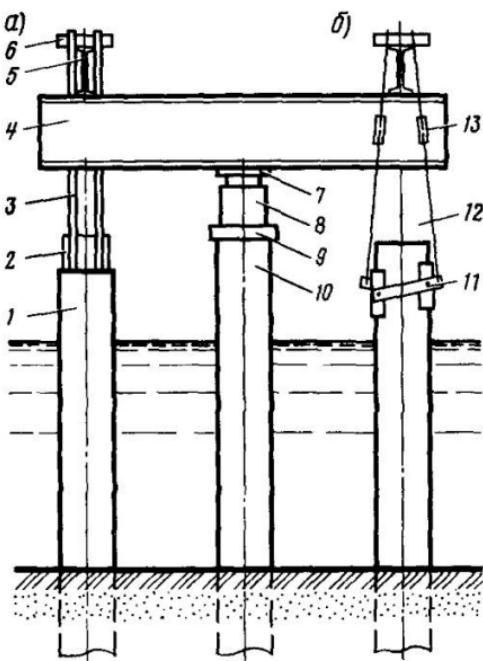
Установка для испытания свай вдавливающей нагрузкой:
